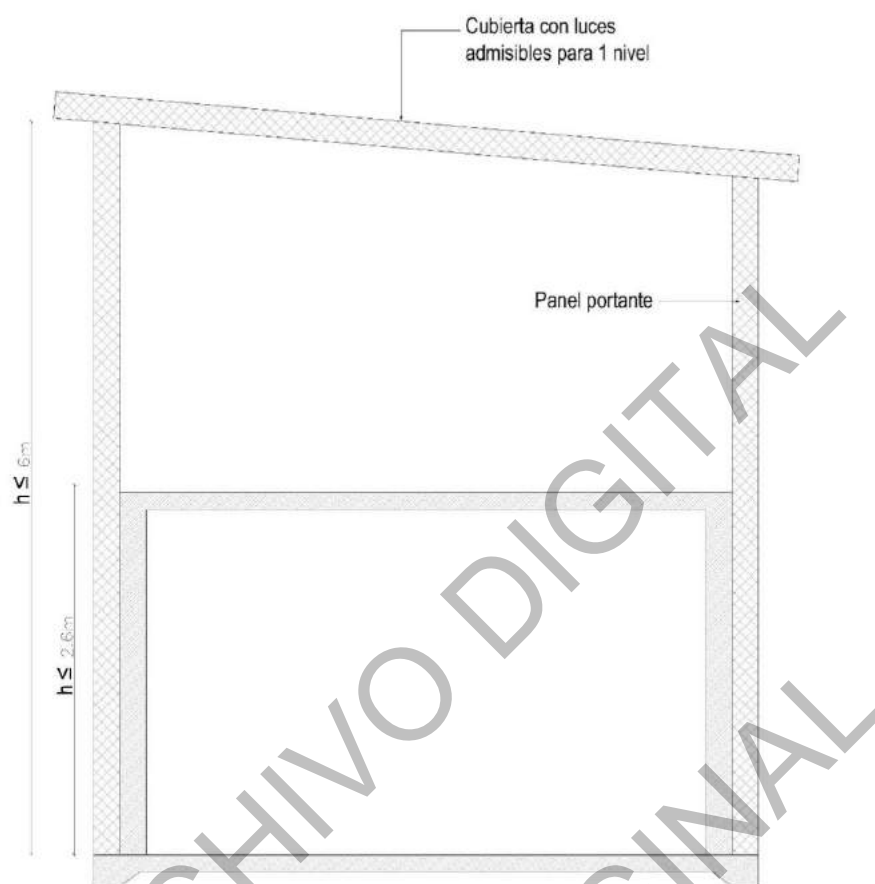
Esquema estructural en tipologías de dos niveles. Estructura independiente de entresijos.
